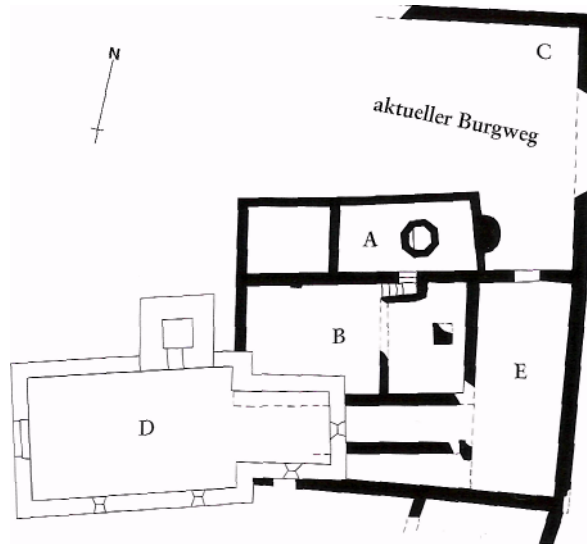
Sils i.D., Burganlage Hohenrätien. Grundrissplan. Schwarz: Seit 2001 entdeckte Mauern im Grabungsgelände. Weiss: Bestehende Bauten.
